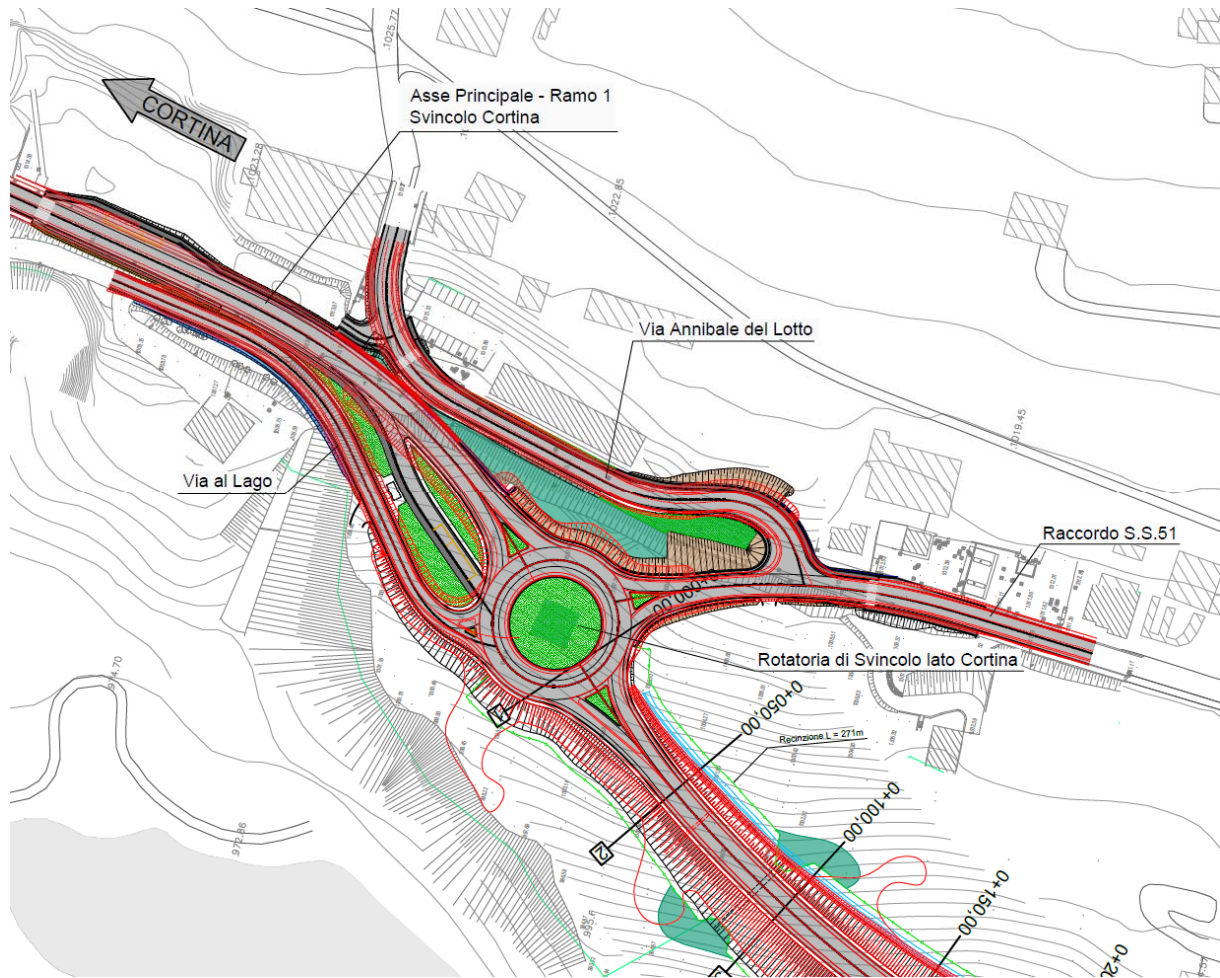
Sovrapposizione Planimetrica di confronto PD PE
